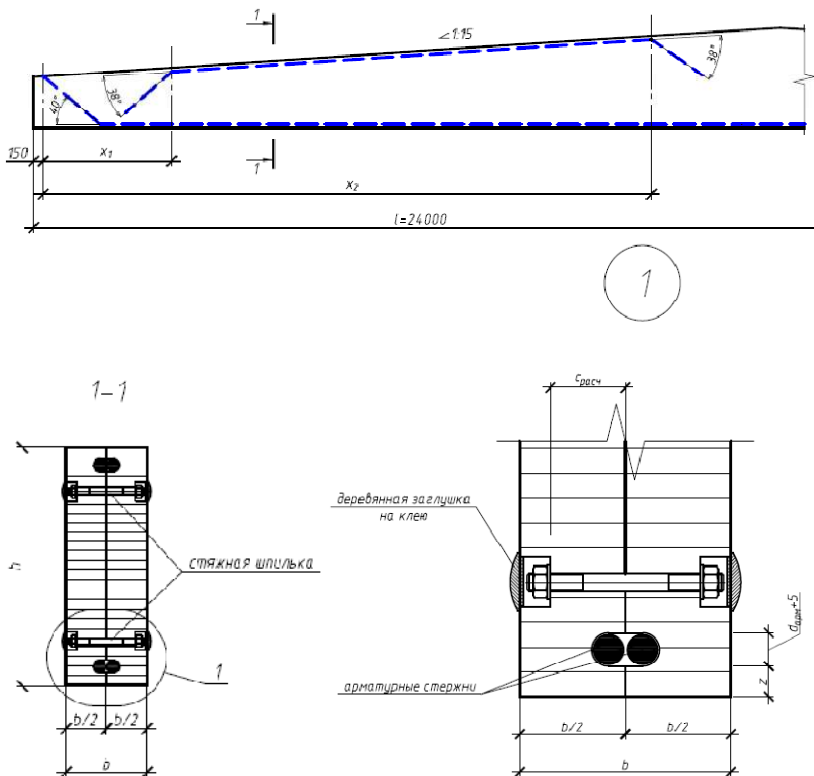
Конструкция и поперечный разрез деревянной двускатной армированной балки
